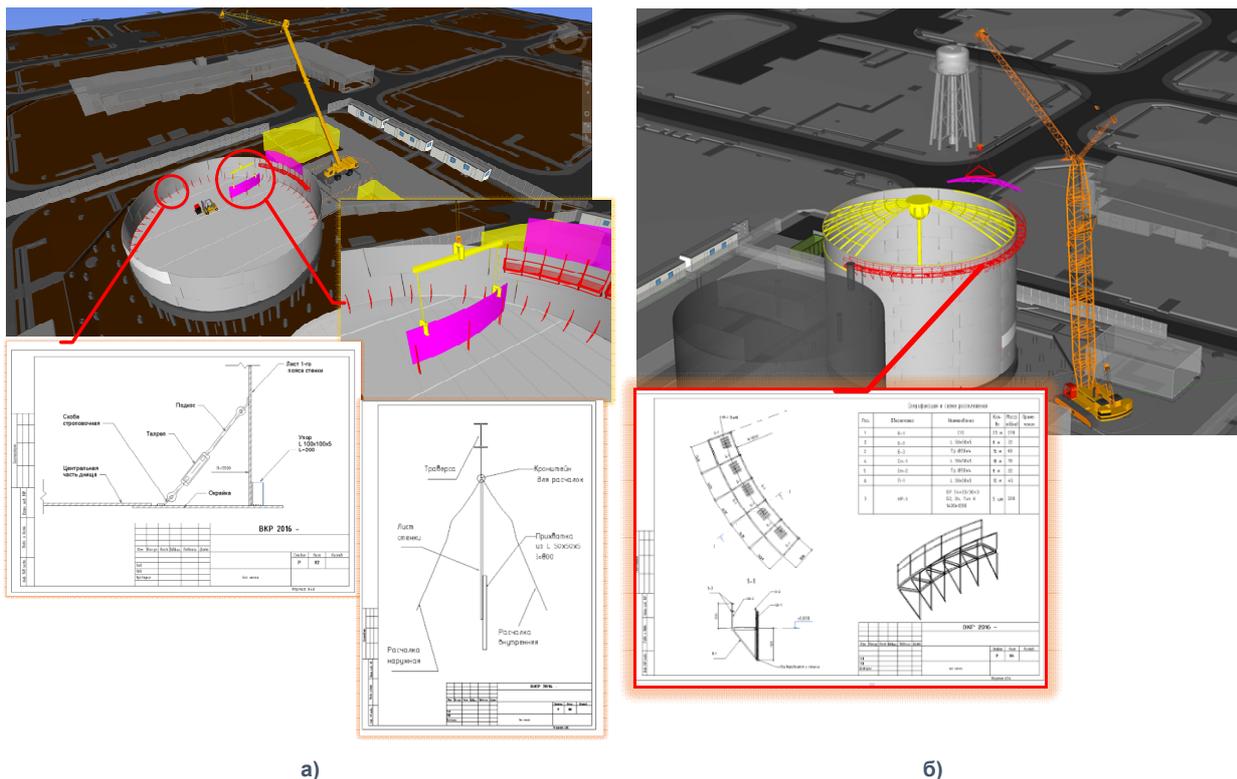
Монтаж листов стенки резервуара (а) и каркаса крыши резервуара (б)
